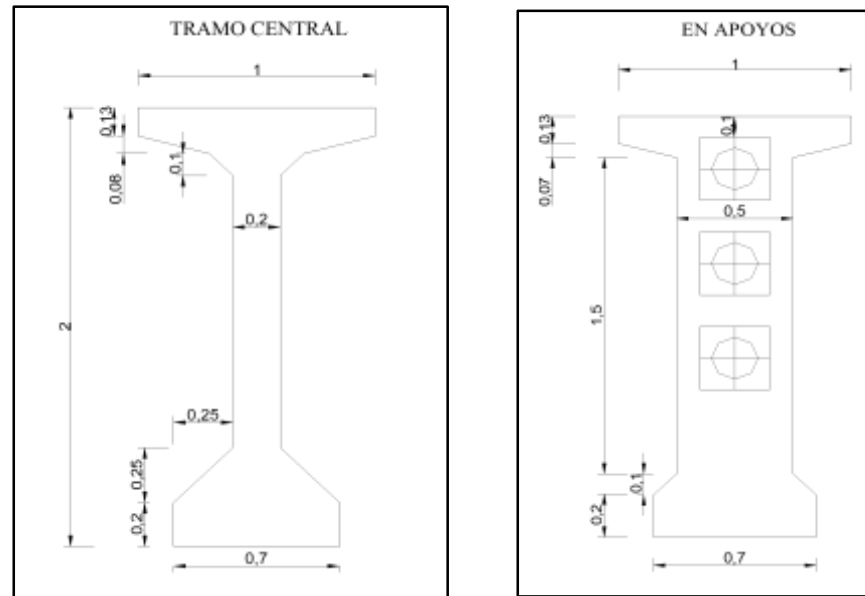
Geometría de viga de hormigón pretensado con armaduras postesas en centro luz y en apoyos (*fuentes elaboración propia*)
